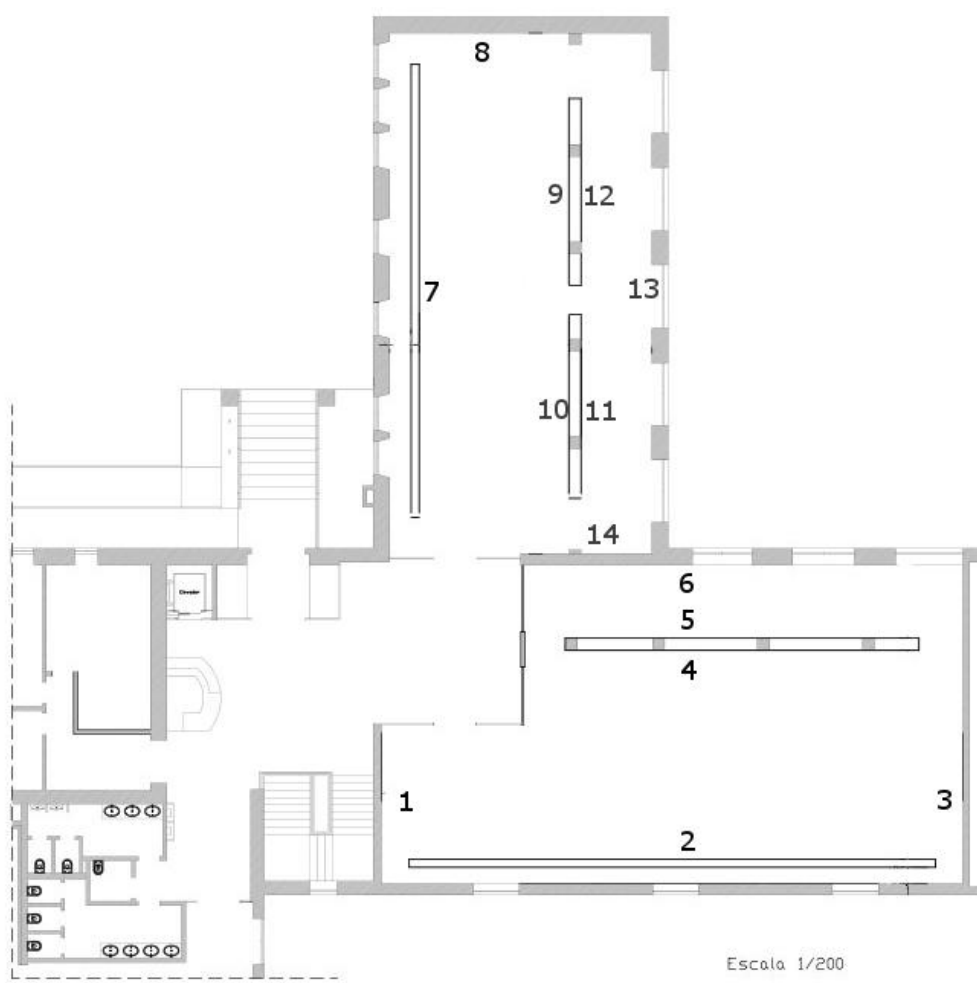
Planta das salas de exposição e numeração das paredes
